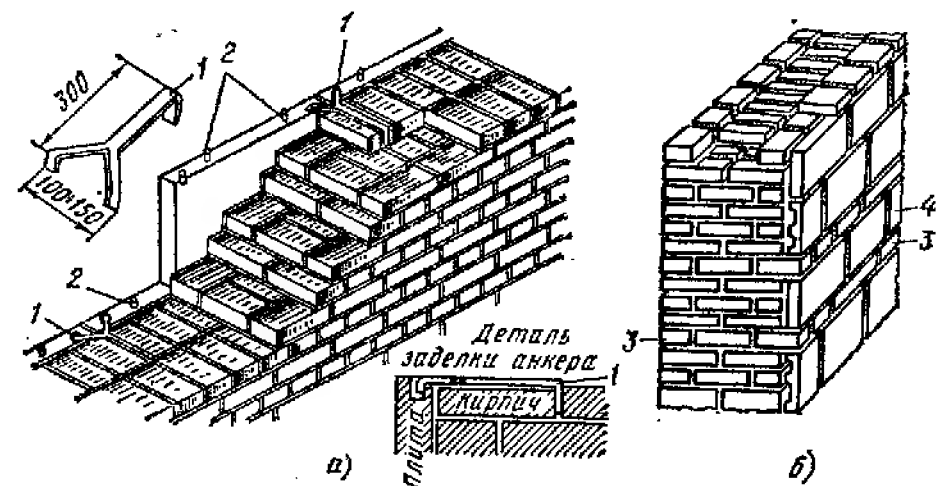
Кладка стен с одновременной облицовкой плитами: а — из природного камня, б — силикатными или керамическими; 1 — анкер, 2 — пирон, 3 — прокладной ряд плит, 4 — прислонные облицовочные плиты
